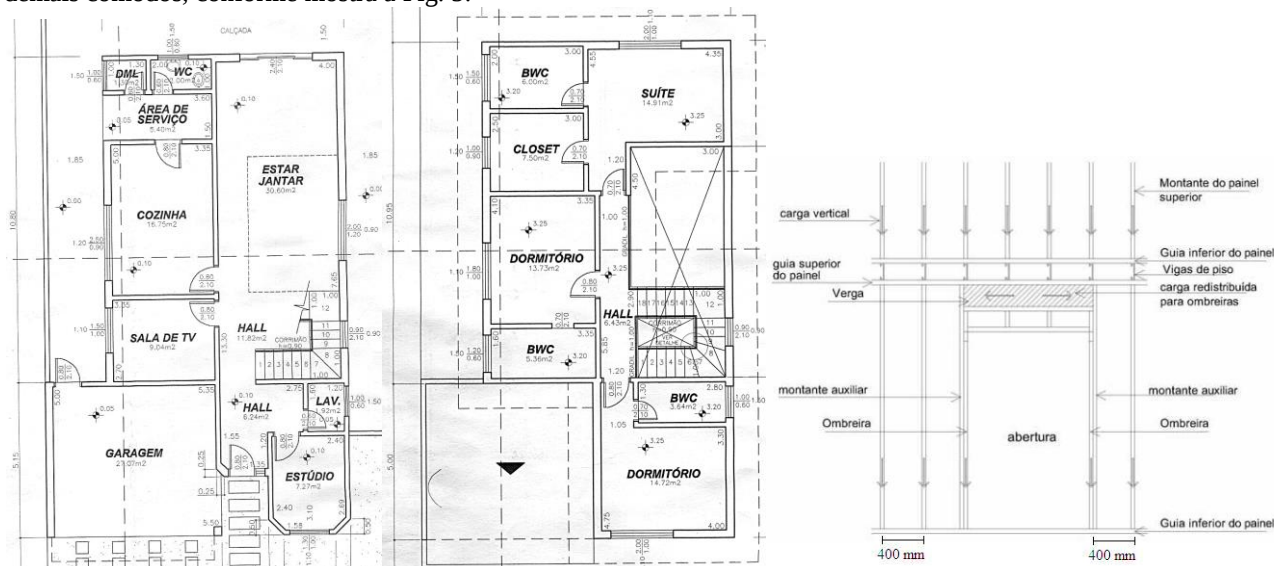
Planta Arquitetônica do Primeiro e segundo Pavimento e diretriz in-line Framing com espaçamento de 400 mm
